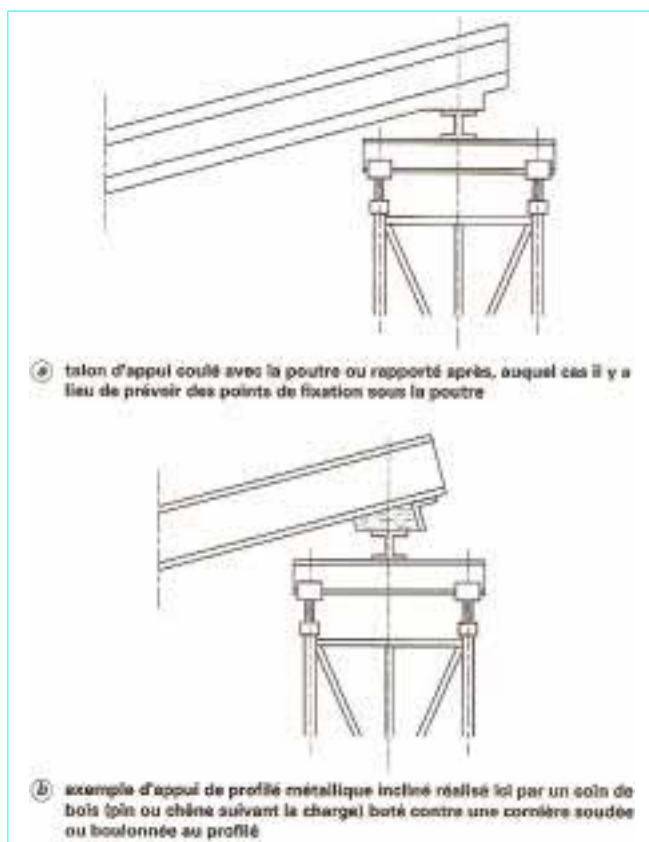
Appui provisoire d'élément incliné (poutre, dalle...) en béton préfabriqué ou profilé métallique
